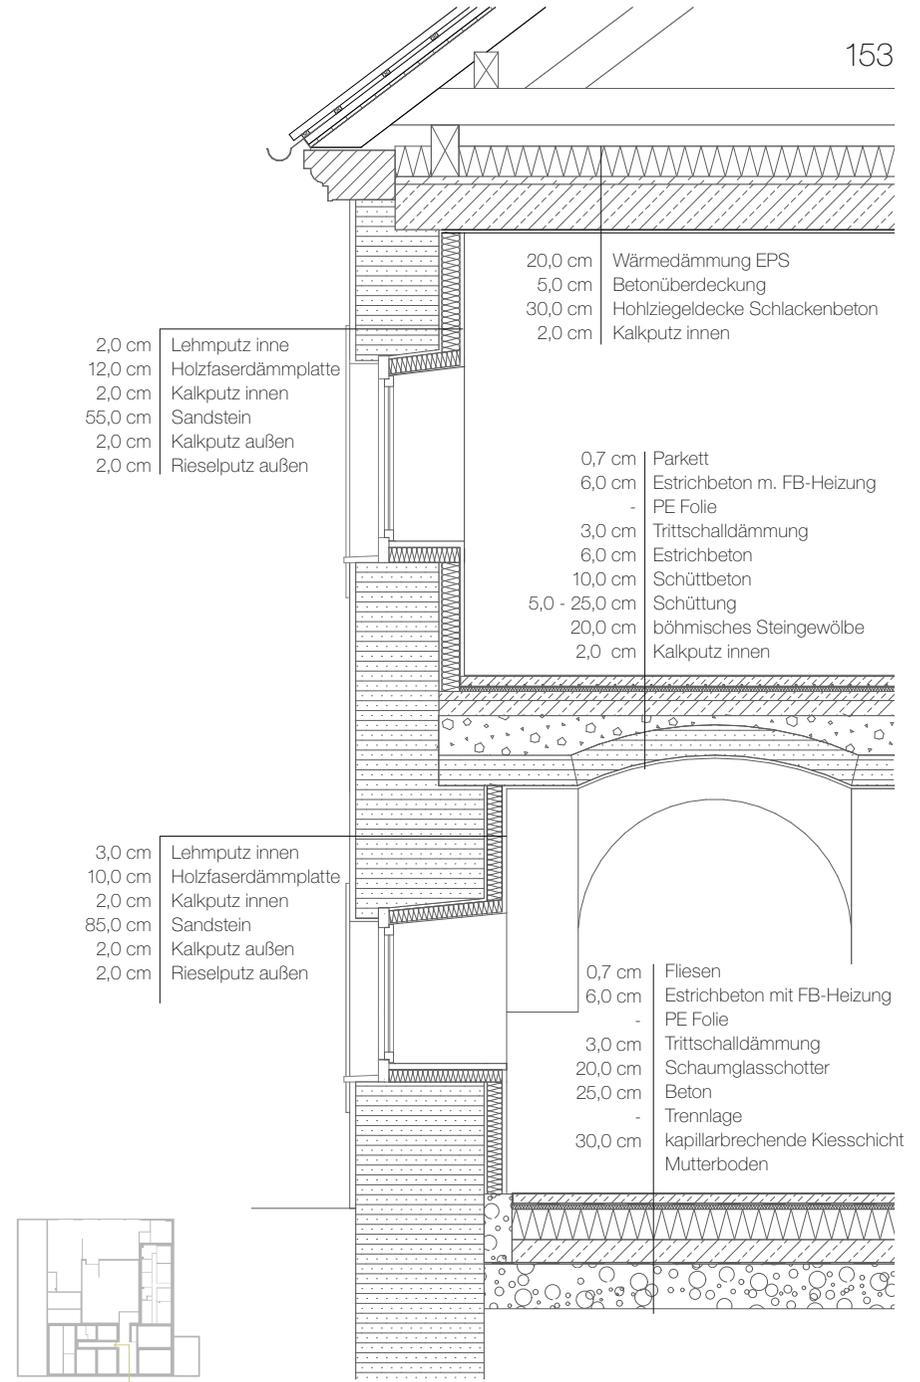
| Fassadenschnitt nach Sanierung | M 1:50
